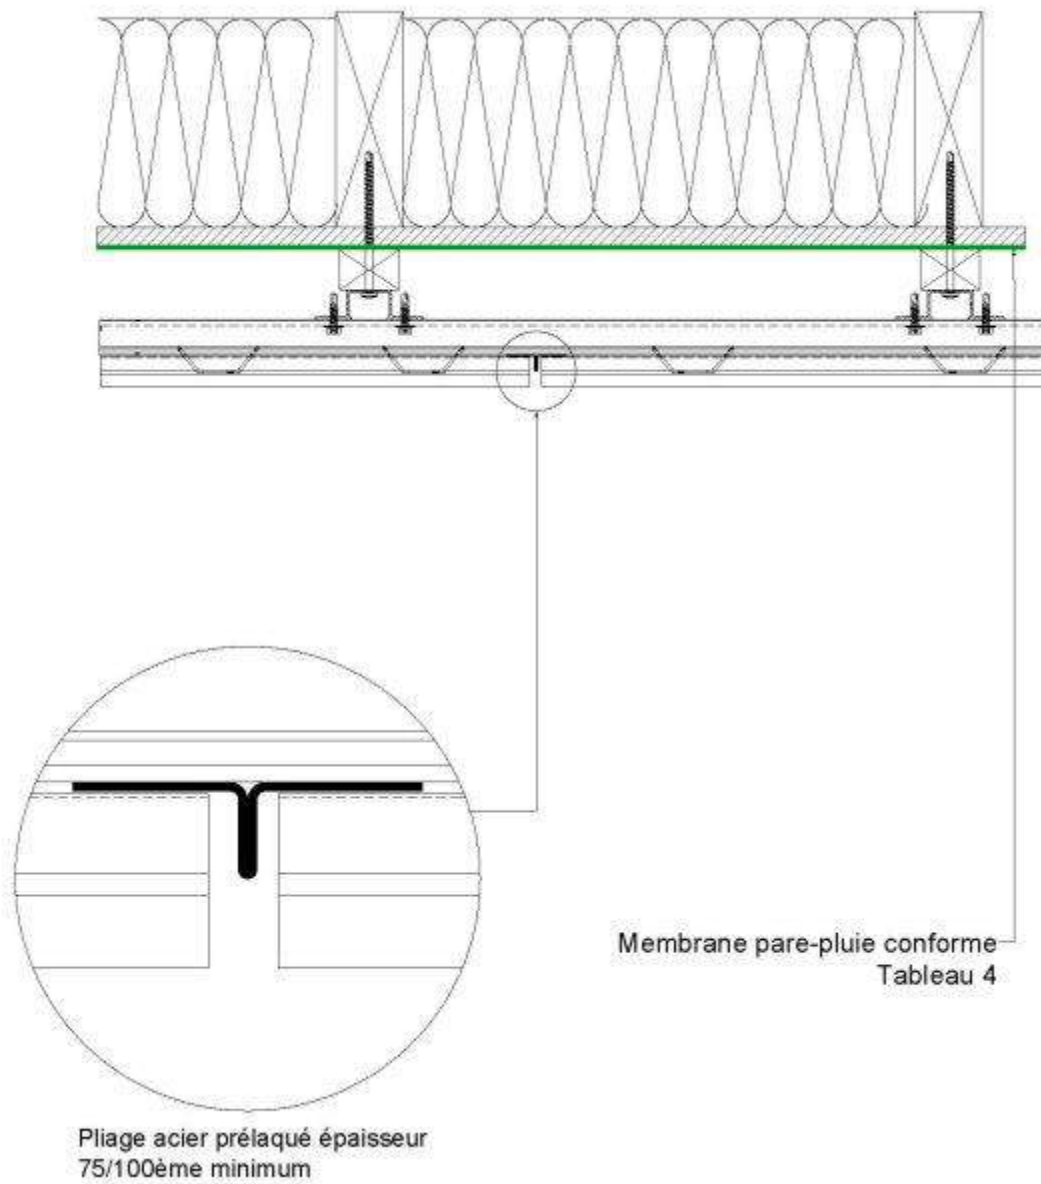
Fermeture des joints verticaux - (Coupe horizontale)
